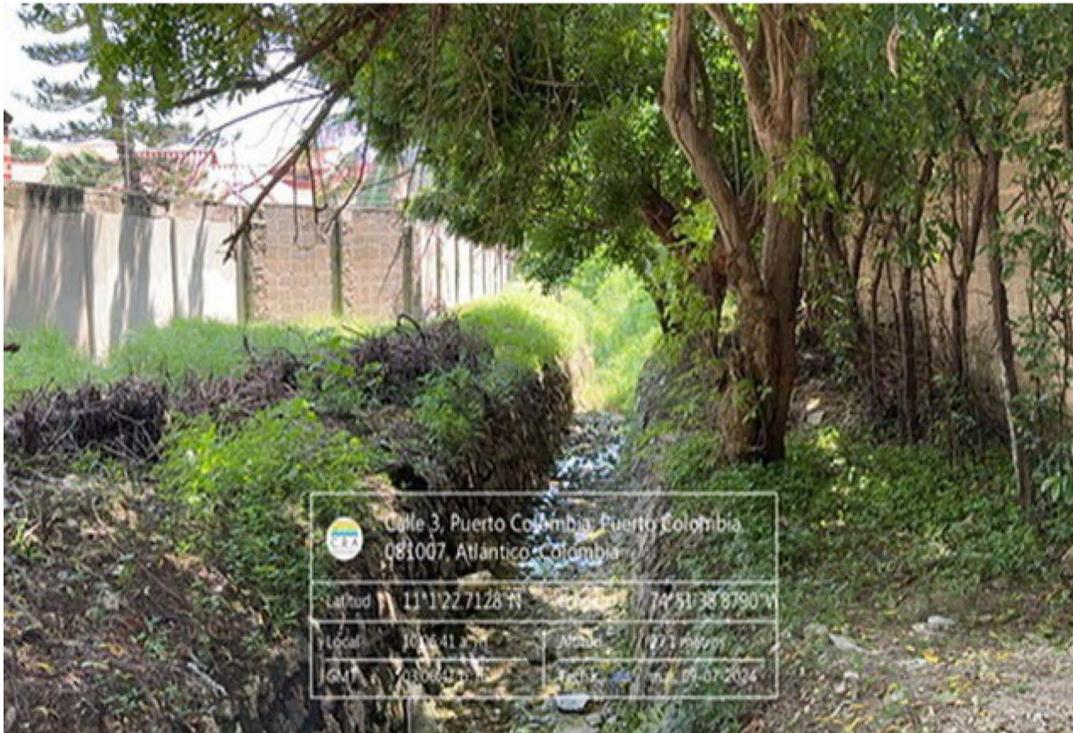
Estructura canal de drenaje, C.R.A
